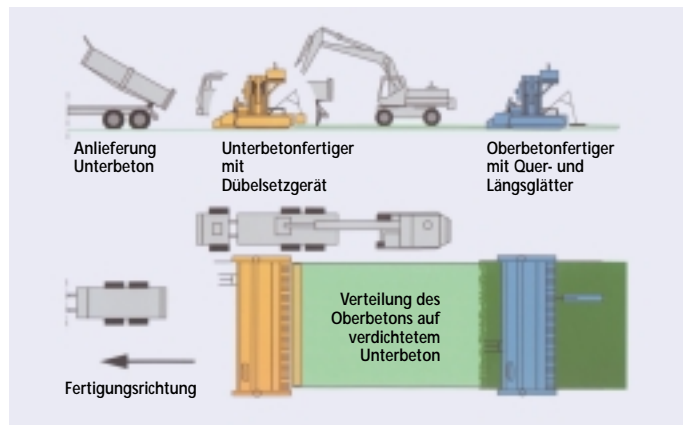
H+W-Betondecken-Einbauzug zur Herstellung von Verkehrsflächen aus Beton in zweischichtiger oder zweilagiger Bauweise (Schema)
